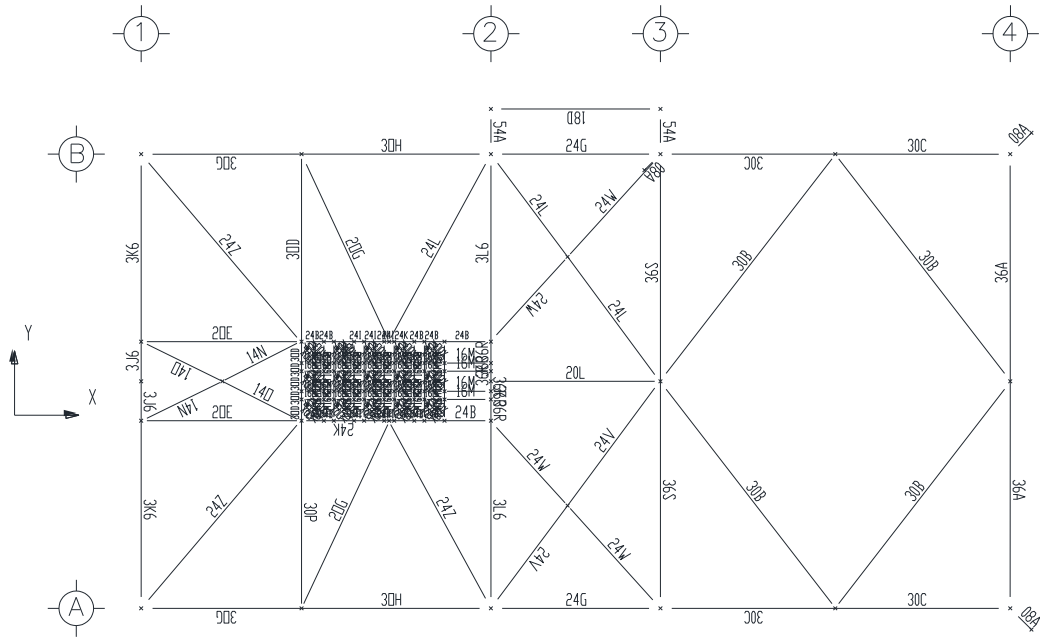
Grupos en Elev. (-) 84.950 m, subestructura
